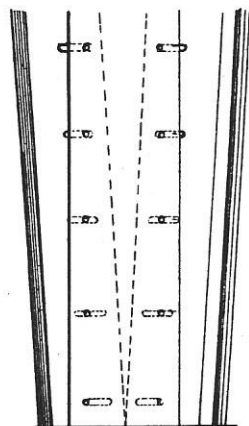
Coupe et élévation d'une palplanche de raccord.
